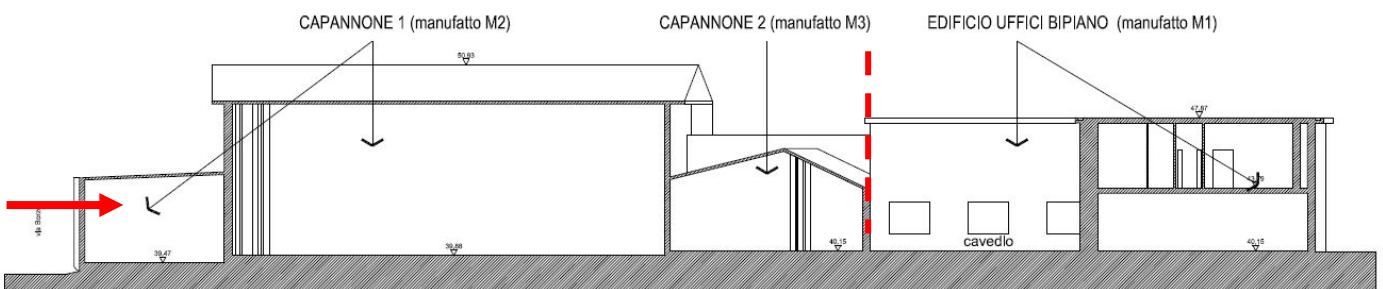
Sezione longitudinale cantiere in fase 1 (edifici M2 e M3)
